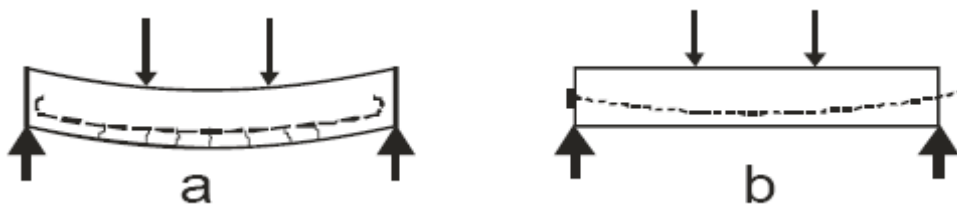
Deformación y agrietamiento en vigas de:
